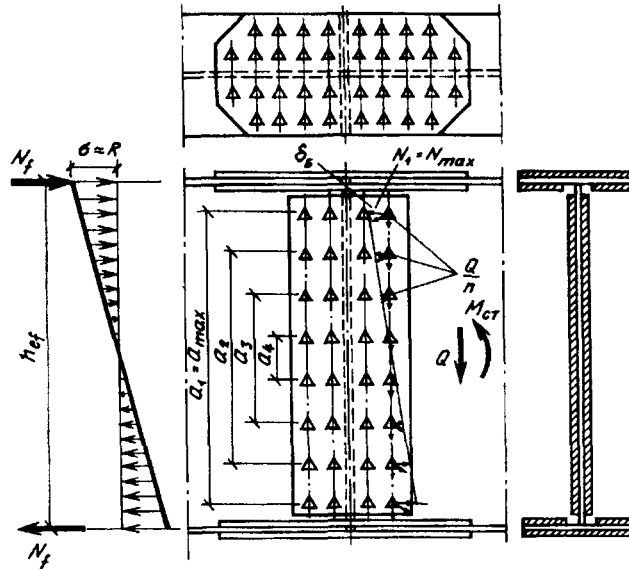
Монтажный стык сварной балки на высокопрочных болтах
